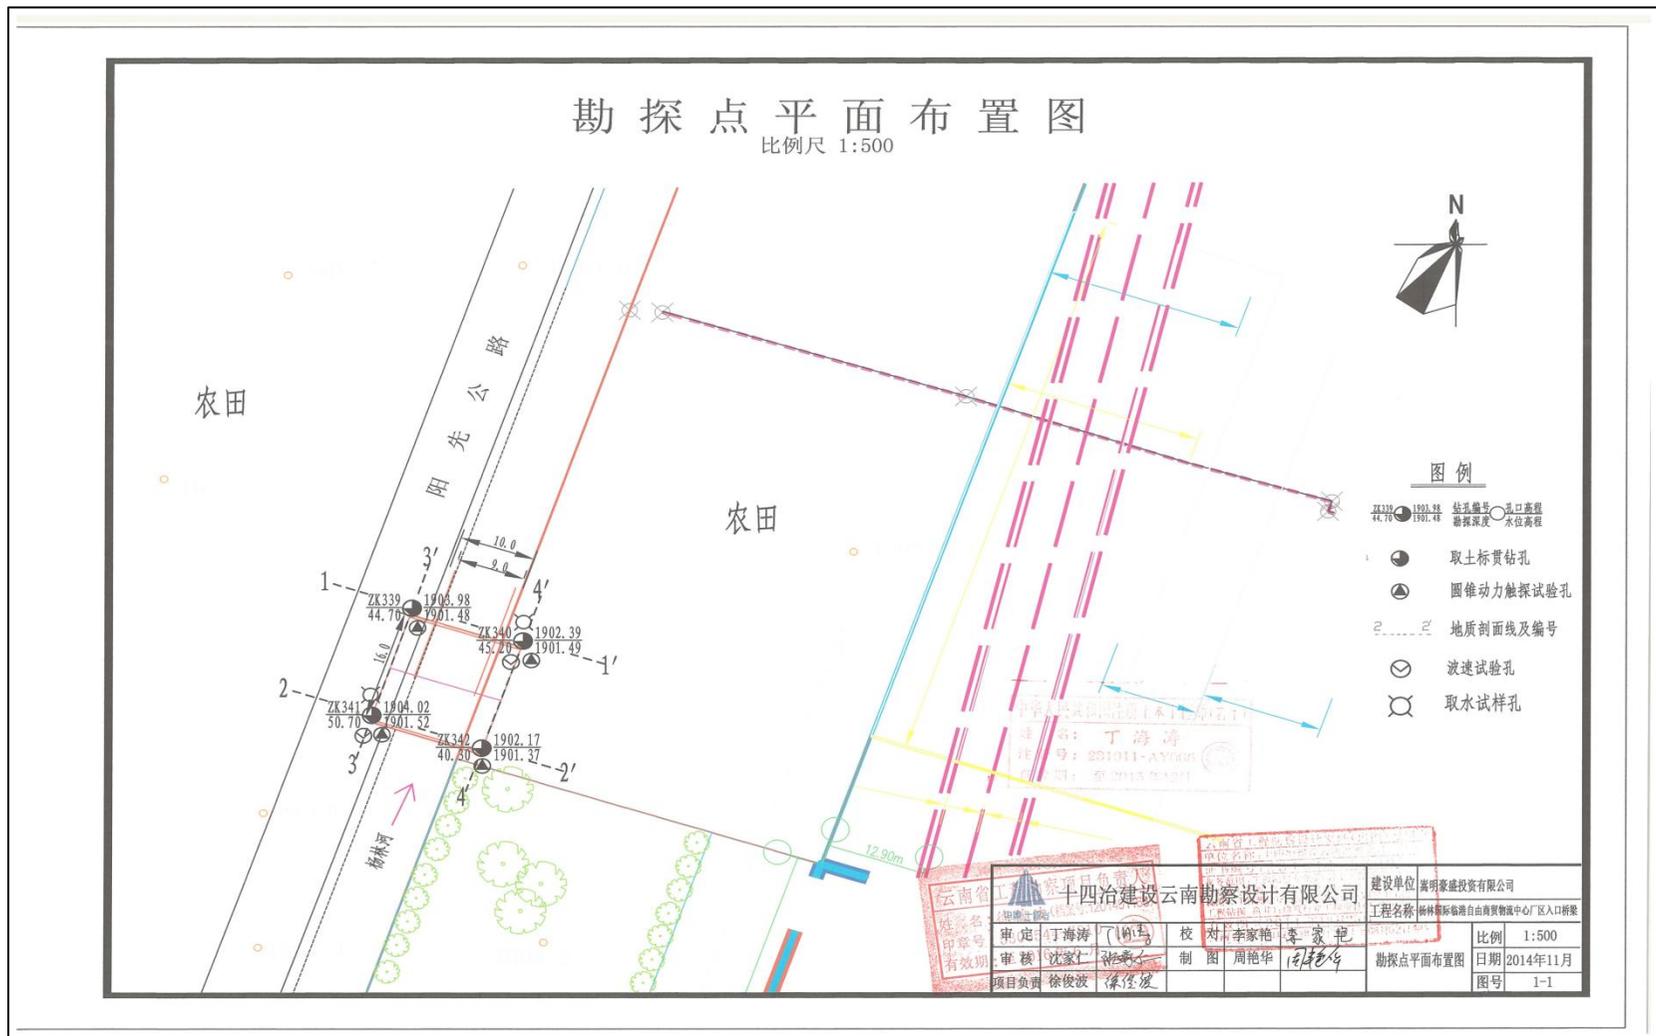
杨林国际临港自由商贸物流中心厂区入口桥梁场地勘探点平面布置图
